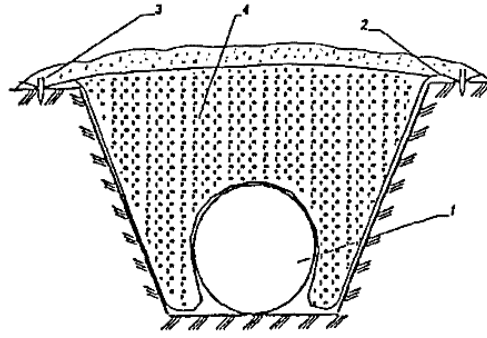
Способ баллаستировки газопроводов минеральным грунтом засыпки с использованием полотнищ из НСМ (для песчаных грунтов) - схема 1:
